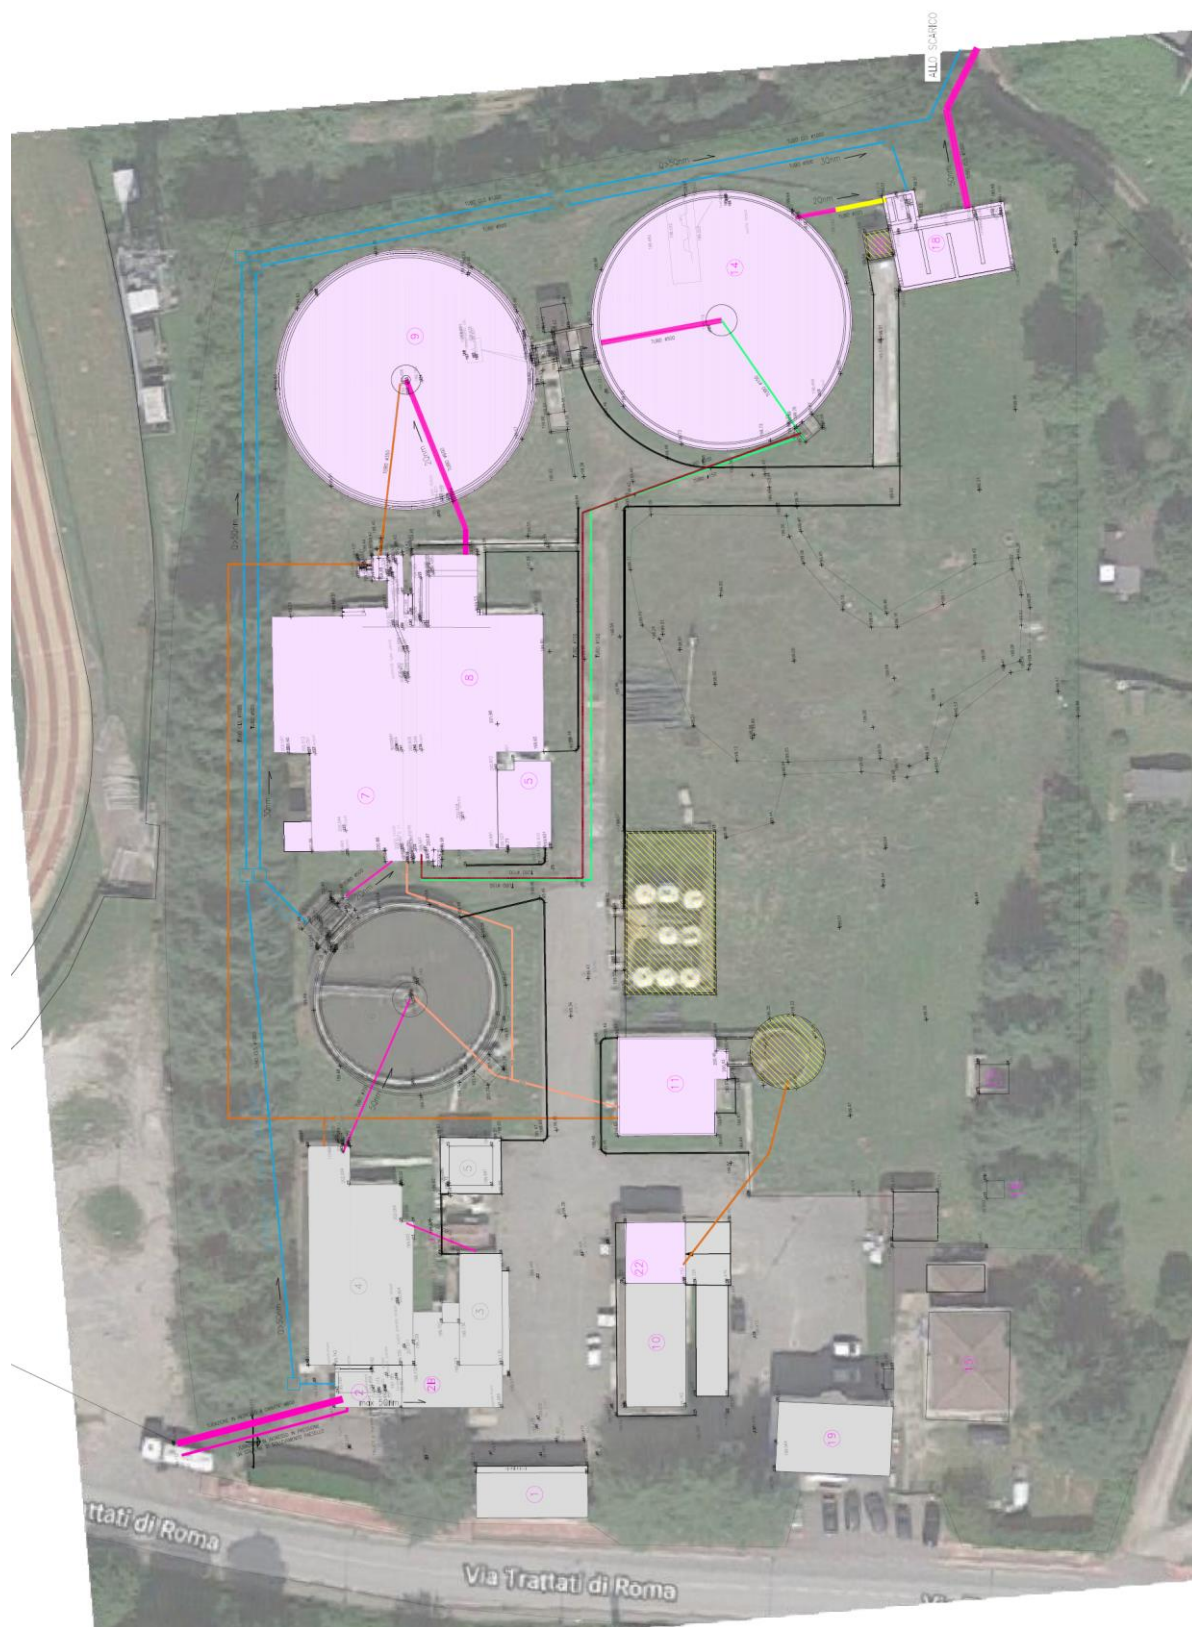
Ortofoto con rappresentazione planimetrica dell’impianto di depurazione esistente.
